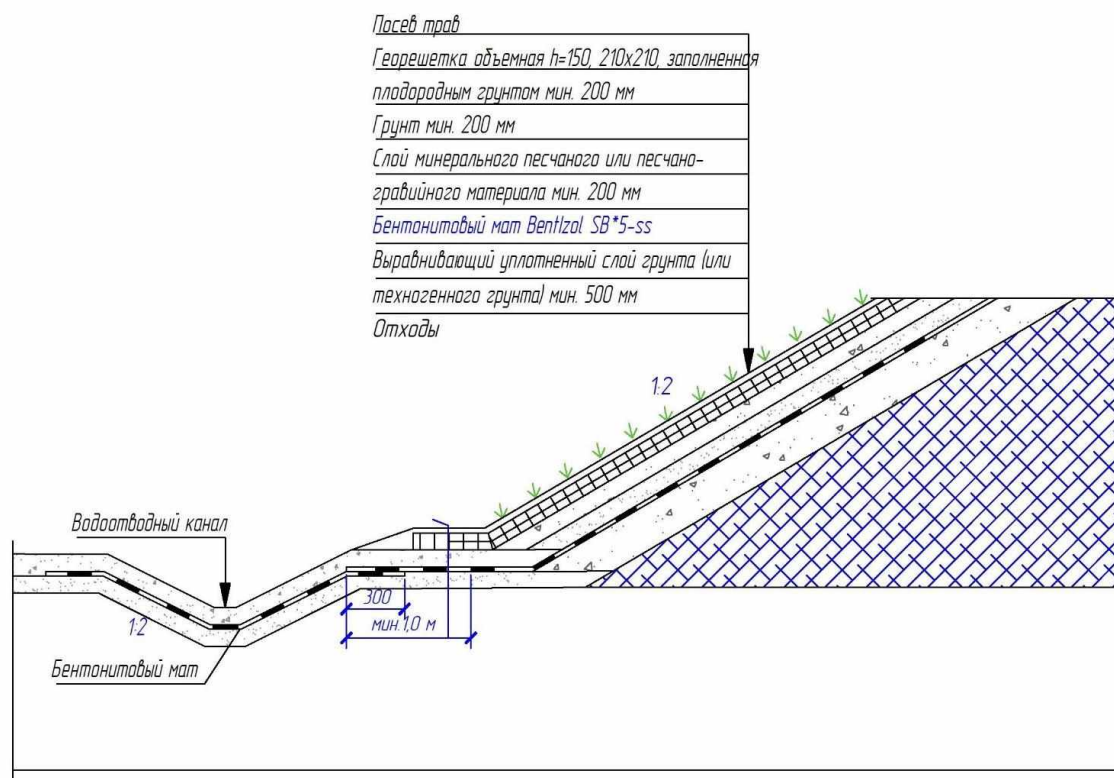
Схема устройства внешнего изолирующего покрытия
